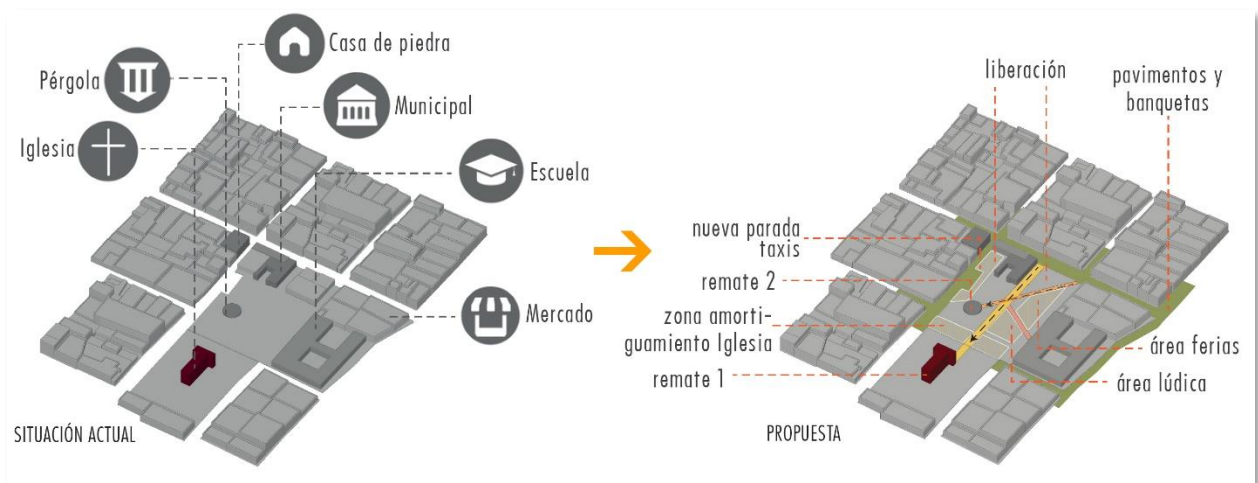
Esquema de la situación actual y el planteamiento de la nueva propuesta para la plaza principal de SCA. Elaboración propia
